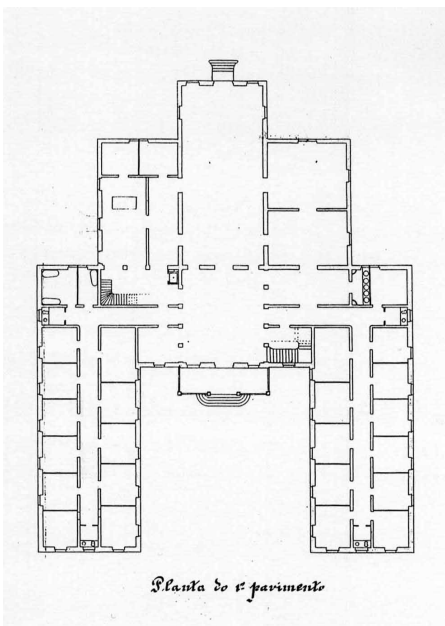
Plan parteru Hotelu da Granja. Wiek XIX. Archiwum prywatne.
